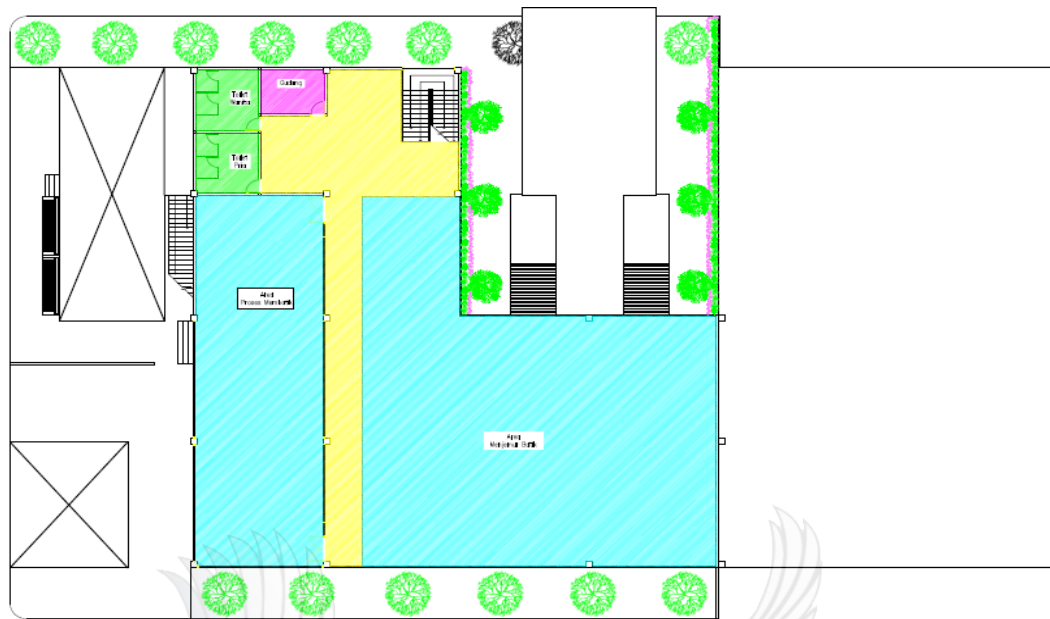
Grouping Zoning Lantai 1 Alternatif 1
